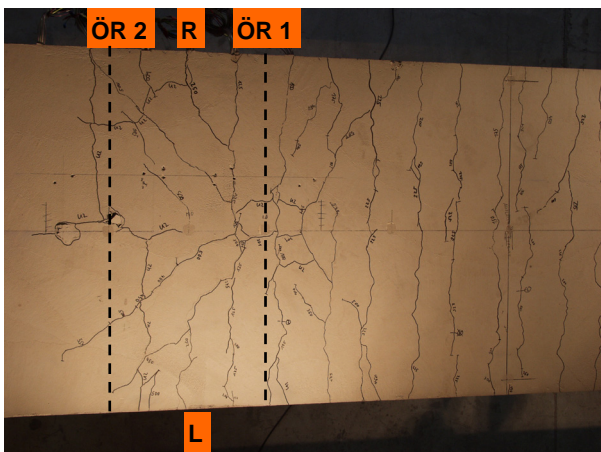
Rissbild auf der Betongurtoberseite
